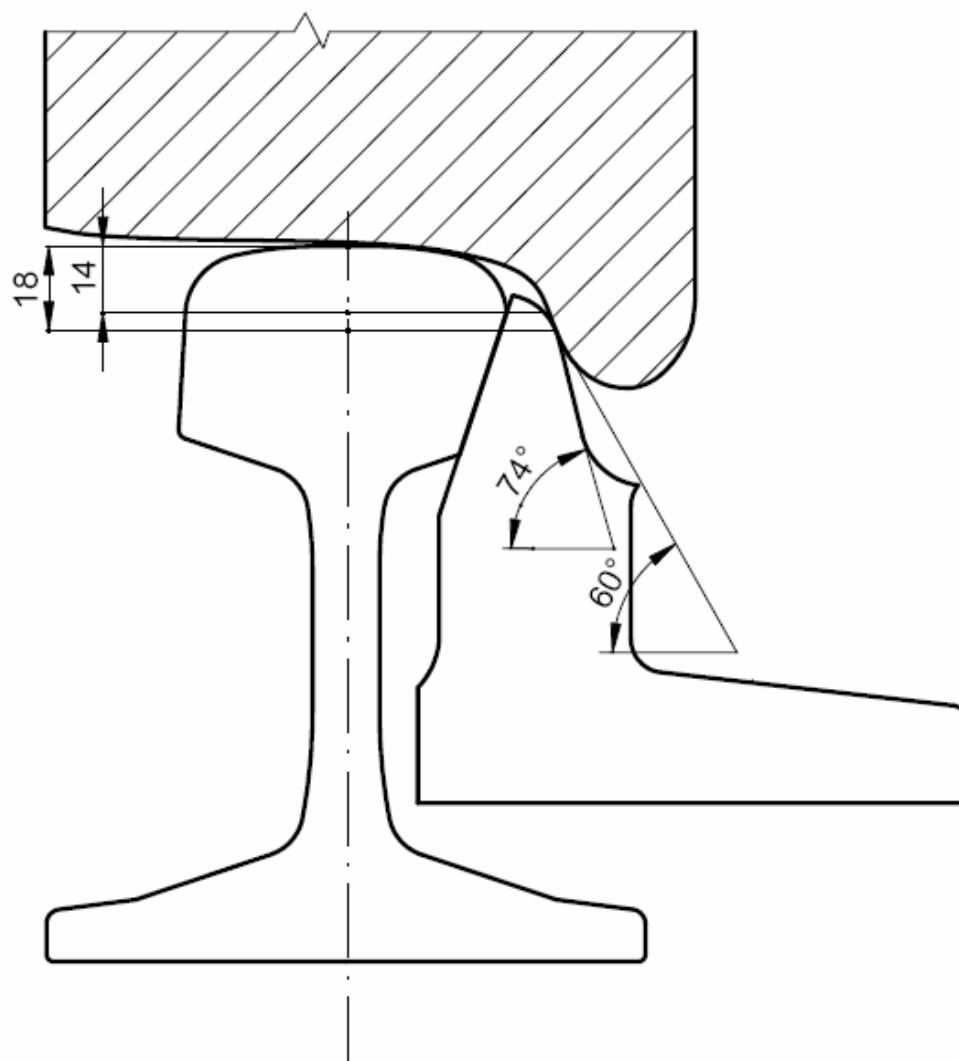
Posúdenie vhodnosti priečneho rezu pri vzniku chyby head checking
